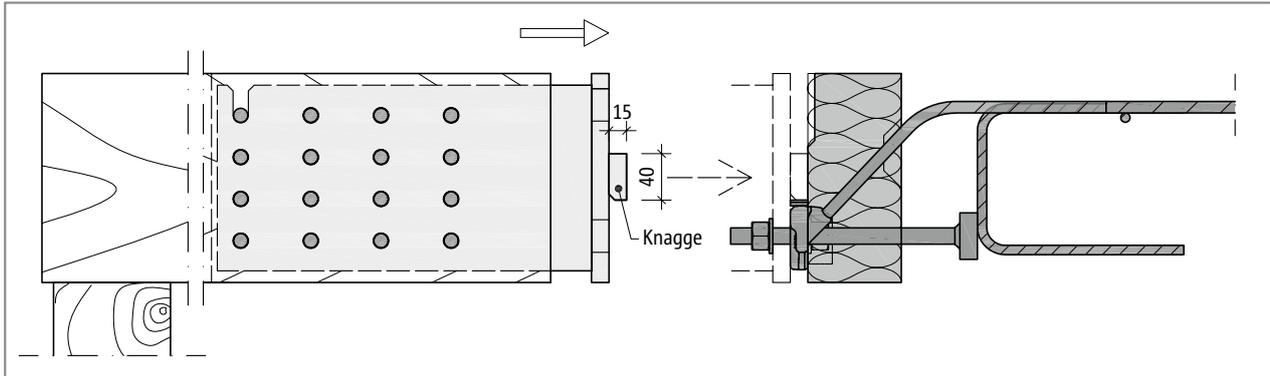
Schöck Isokorb® T Typ SQ mit Stahlschwert: Anschluss des Holzträgers
